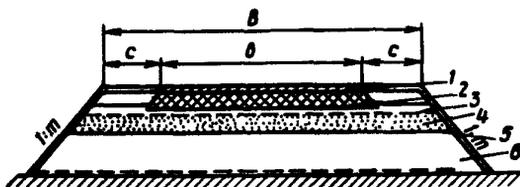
Конструкция дорожной одежды переходного типа на первой стадии при двухстадийном строительстве с армированием песчаного морозозащитного слоя геосеткой: 1 - покрытие; 2 - щебеночное основание; 3 - армирующий элемент из геосетки; 4 - морозозащитный (дренирующий) слой; 5 - разделяющая прослойка из геотекстиля; 6 - грунт повышенной влажности в пределах рабочего слоя и насыпи с $K_y = 0,95$
